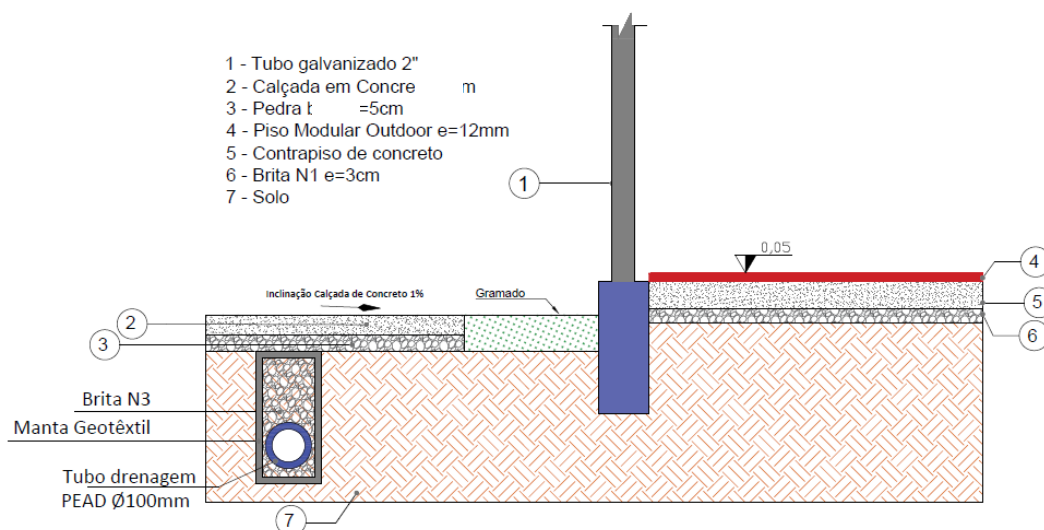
Detalhe tubo de drenagem (Fonte: Autor/2025)
